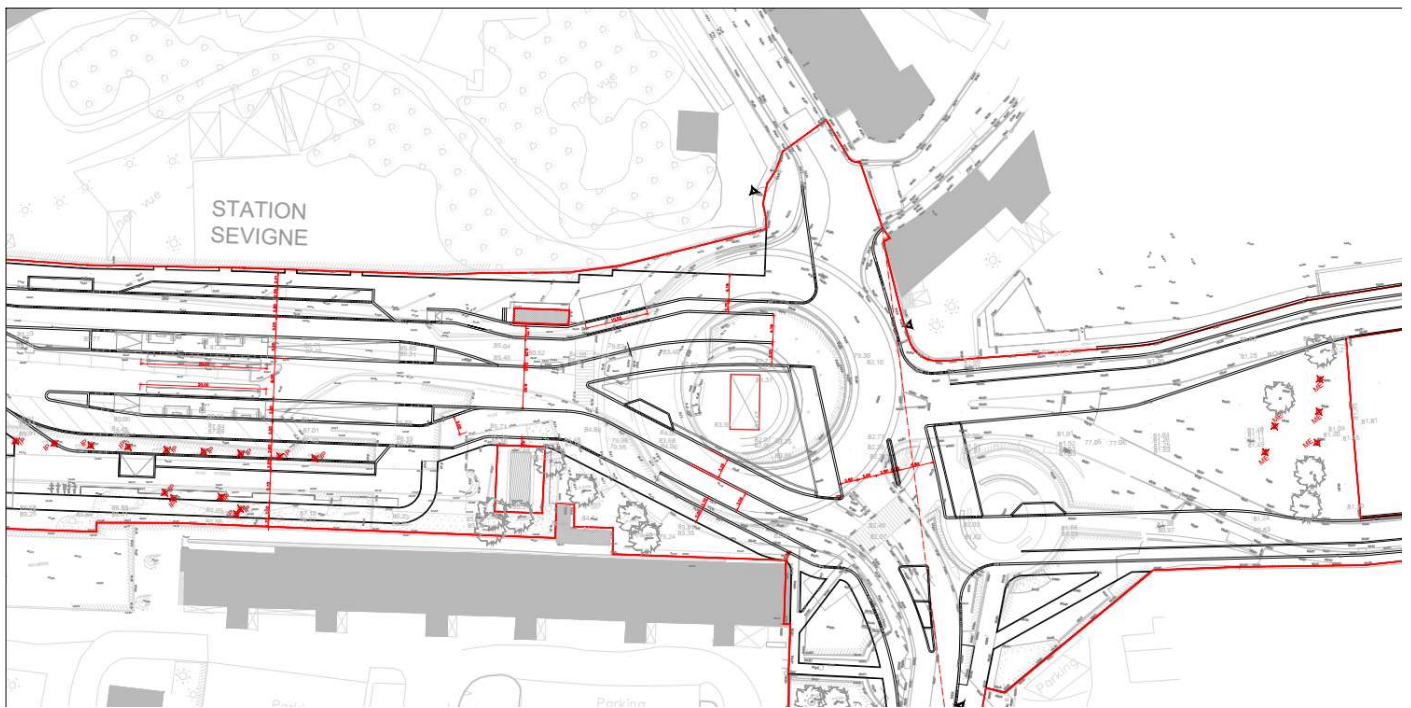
Plan d'abattage d'arbres - Station Sévigné
